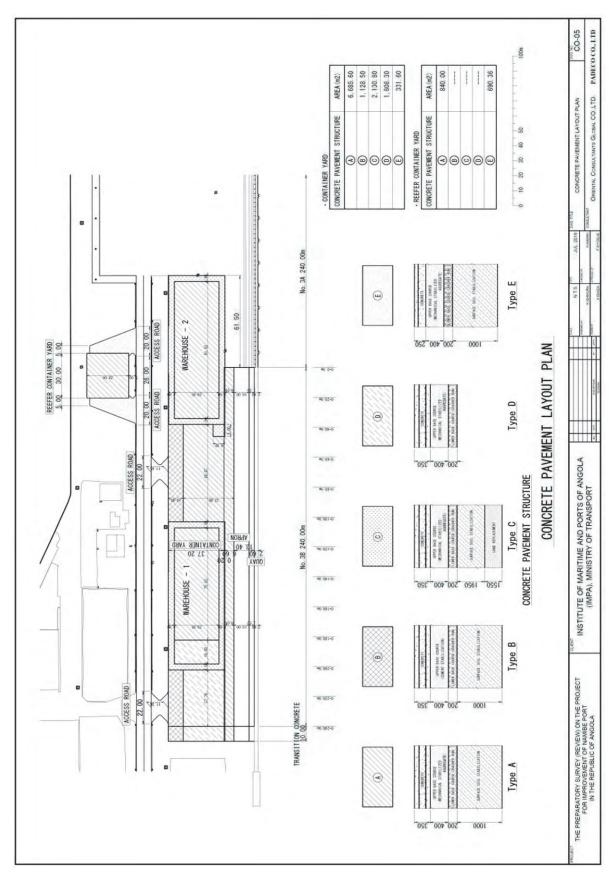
Planta de Divisão da Pavimentação em Lotes
